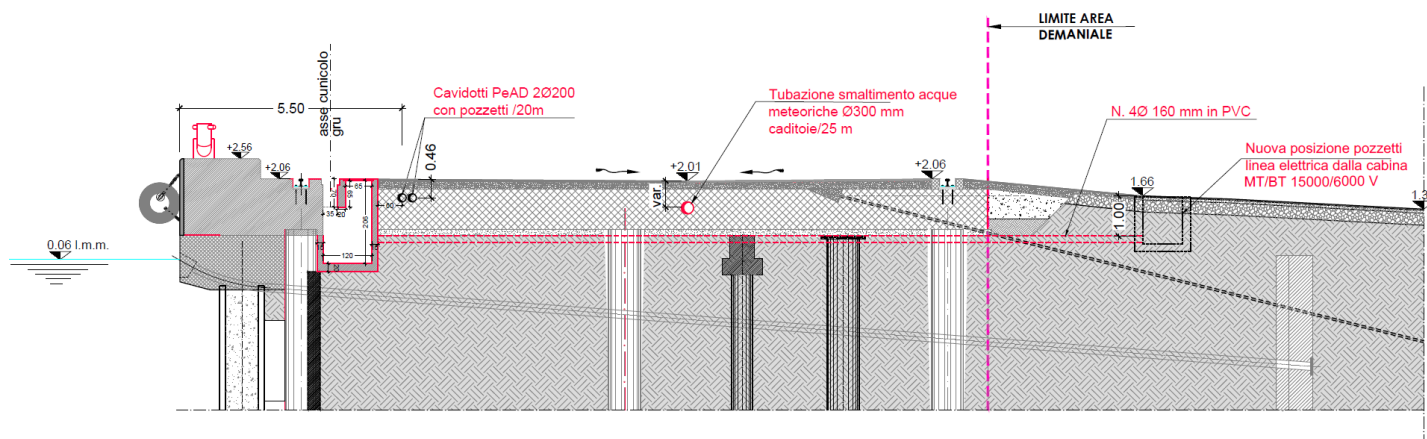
Sezione di progetto con indicazione della posizione delle predisposizioni impiantistiche
